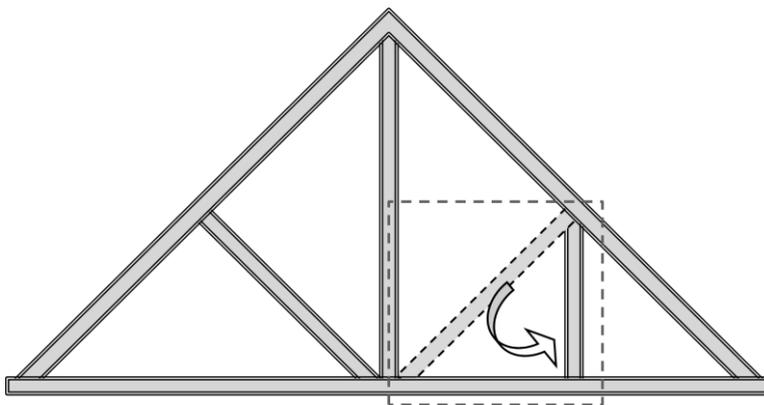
exemple de dégagement d'un espace habitable sous la toiture
